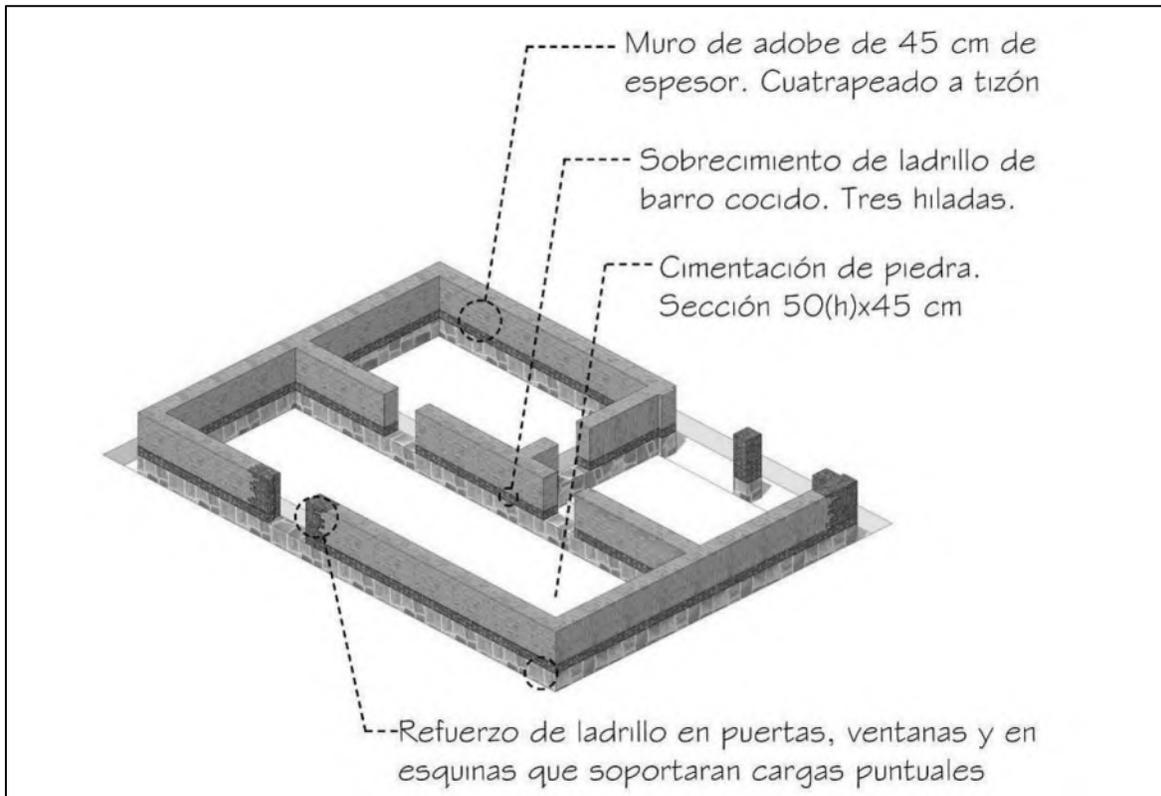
Proceso constructivo de la casa de adobe. Cimentación y desplante de muros. Fuente: elaboración propia.
